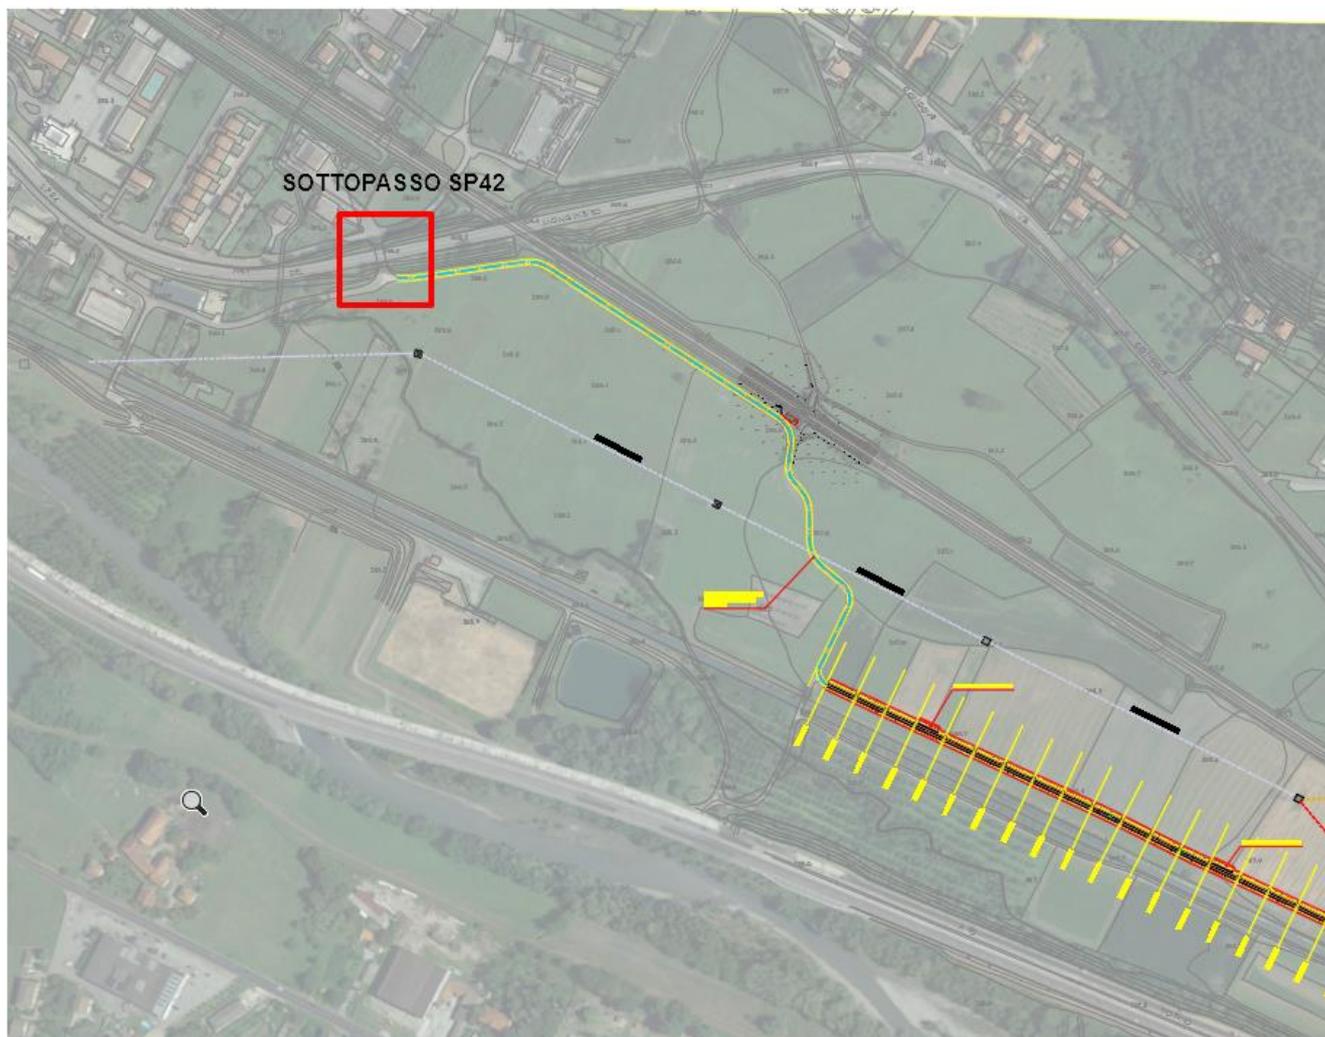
Intersezione strada di collegamento alla nuova SSE.
